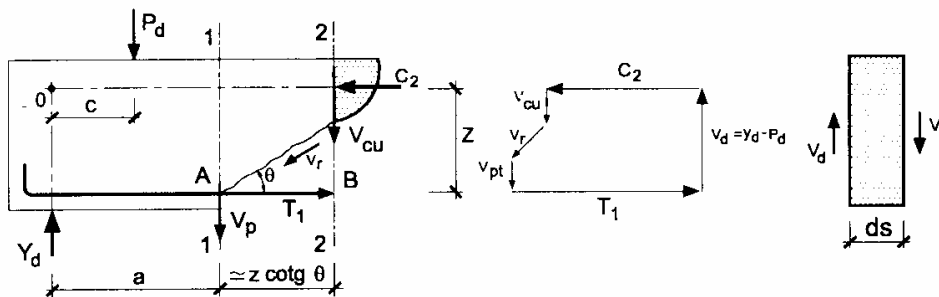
Fuerzas externas e internas en la sección fisurada (Proyecto y Cálculo de Estructuras de Hormigón / Calavera)
